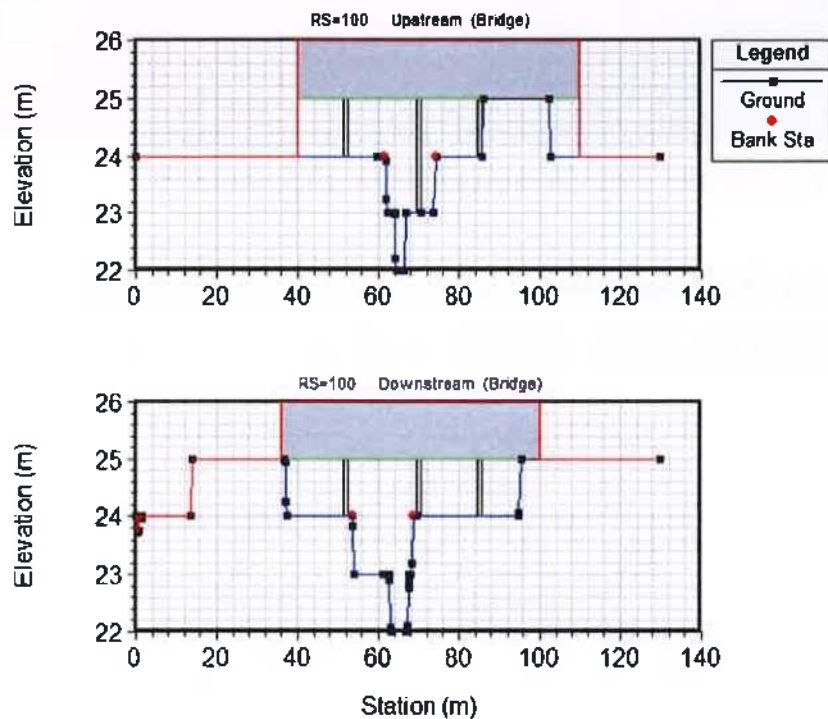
Estructura en el Drenaje 1. Columnas o pilotes.
